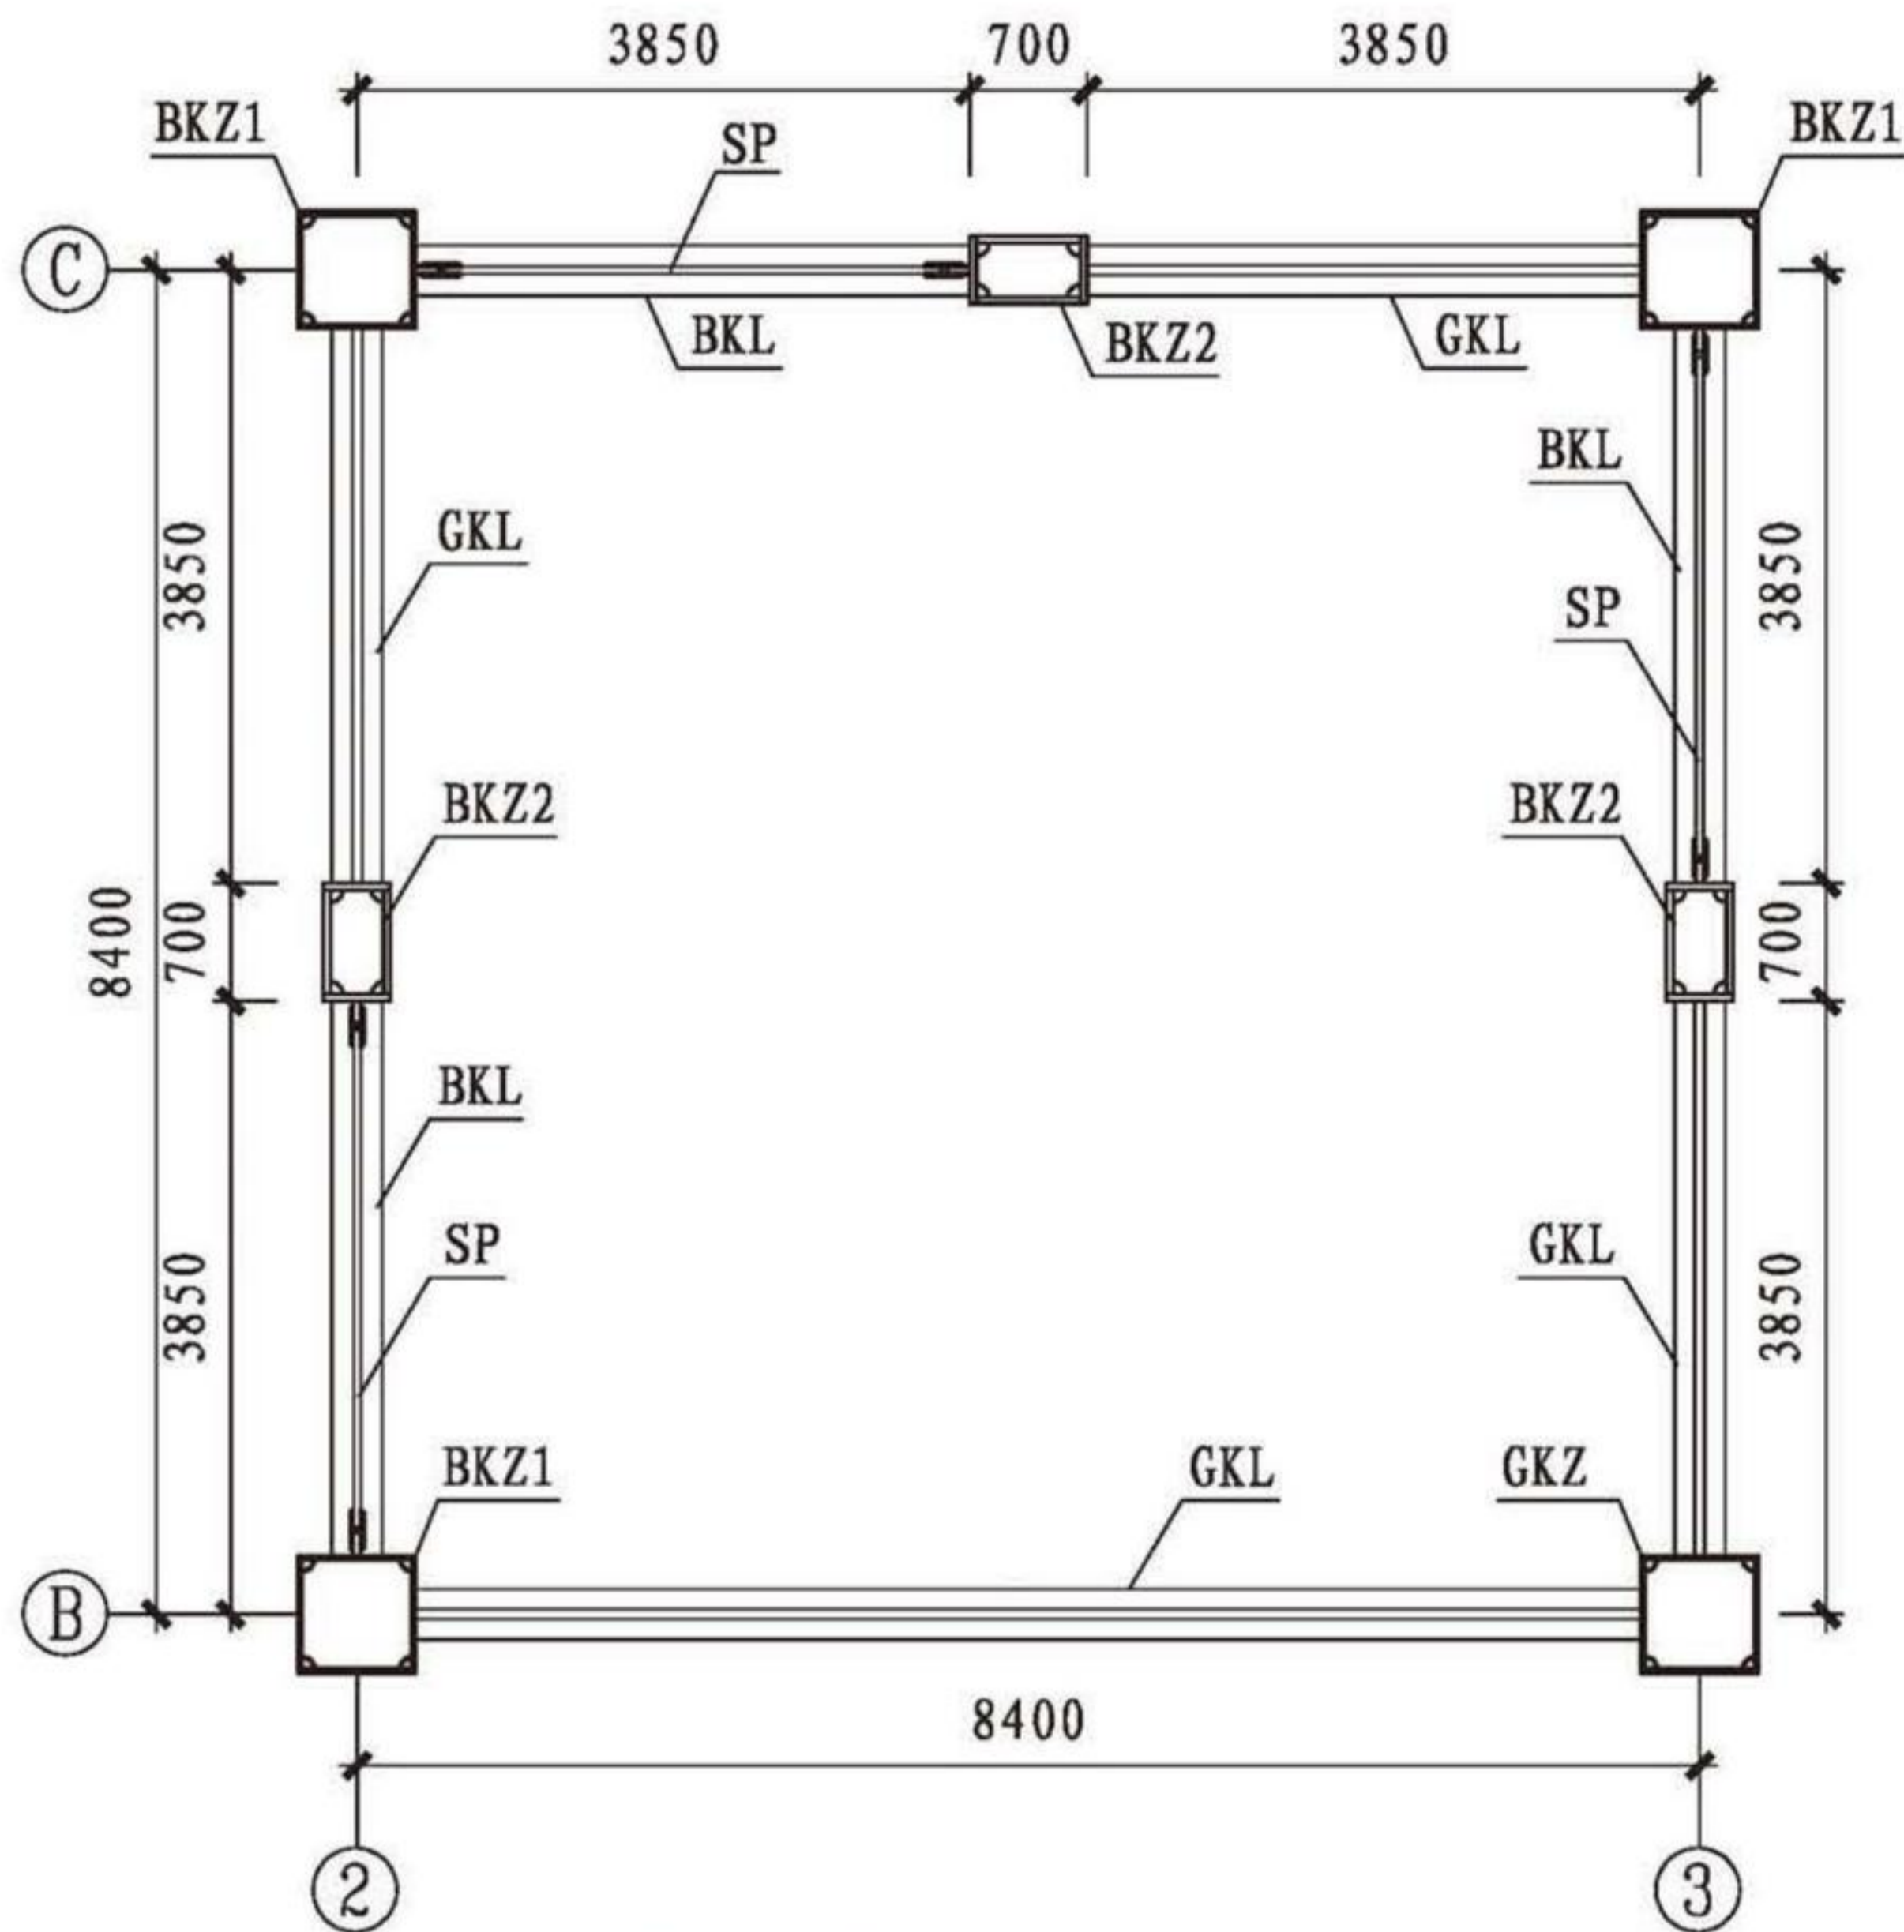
②~③轴×①~②轴钢板剪力墙平面布置图
